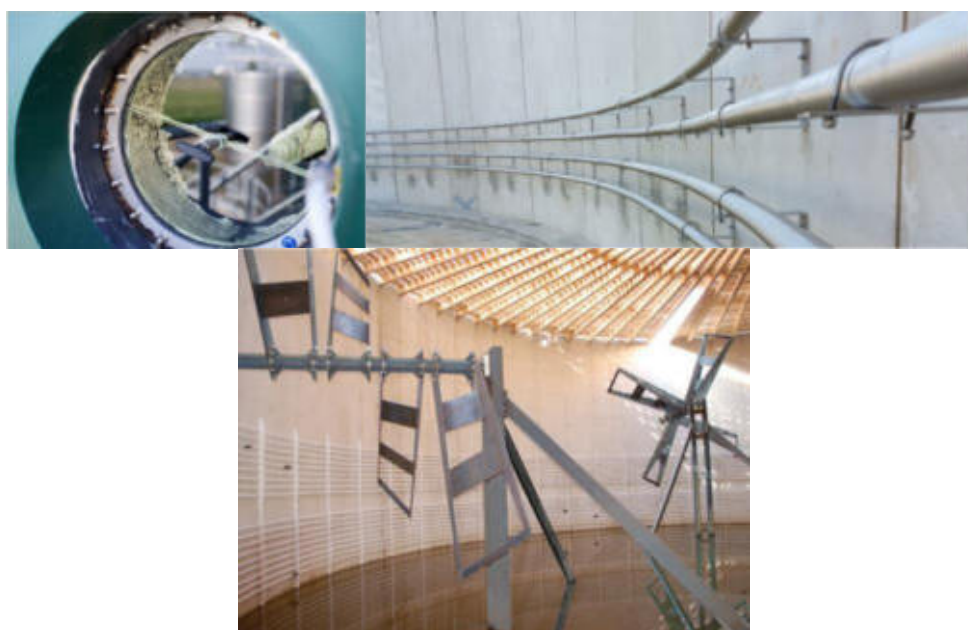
Mirilla de inspección. Sistema de calentamiento de digestores. Agitador de palas.
